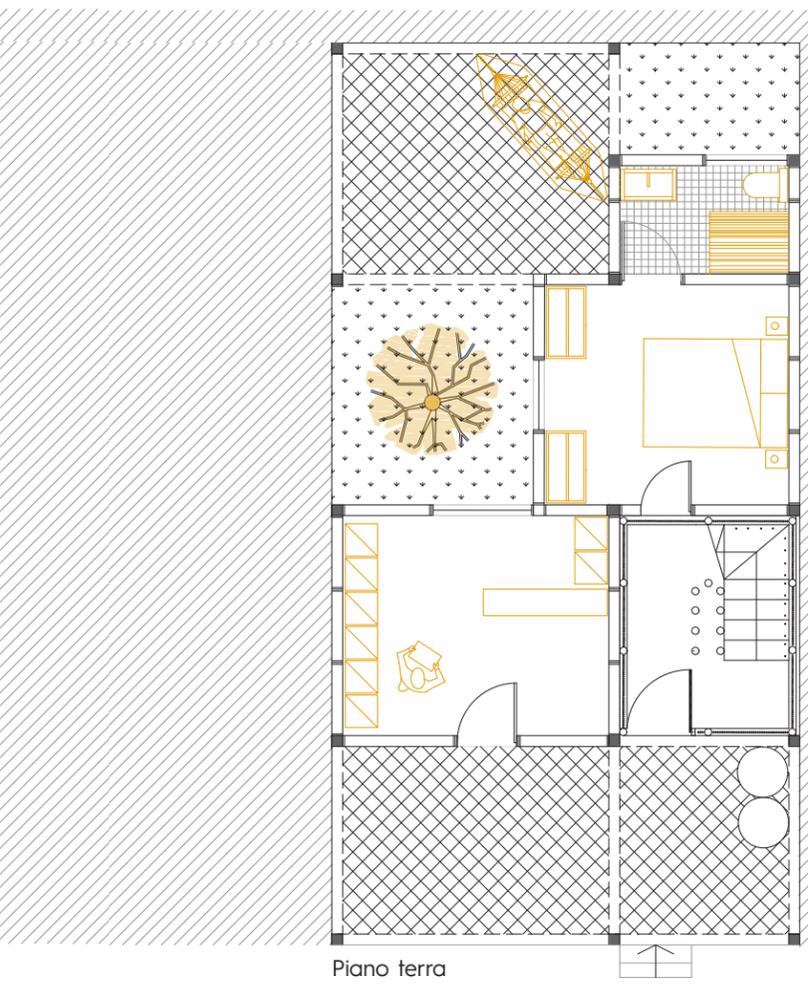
Piante. scala 1:100. Fonte: elaborazione propria della autrici
